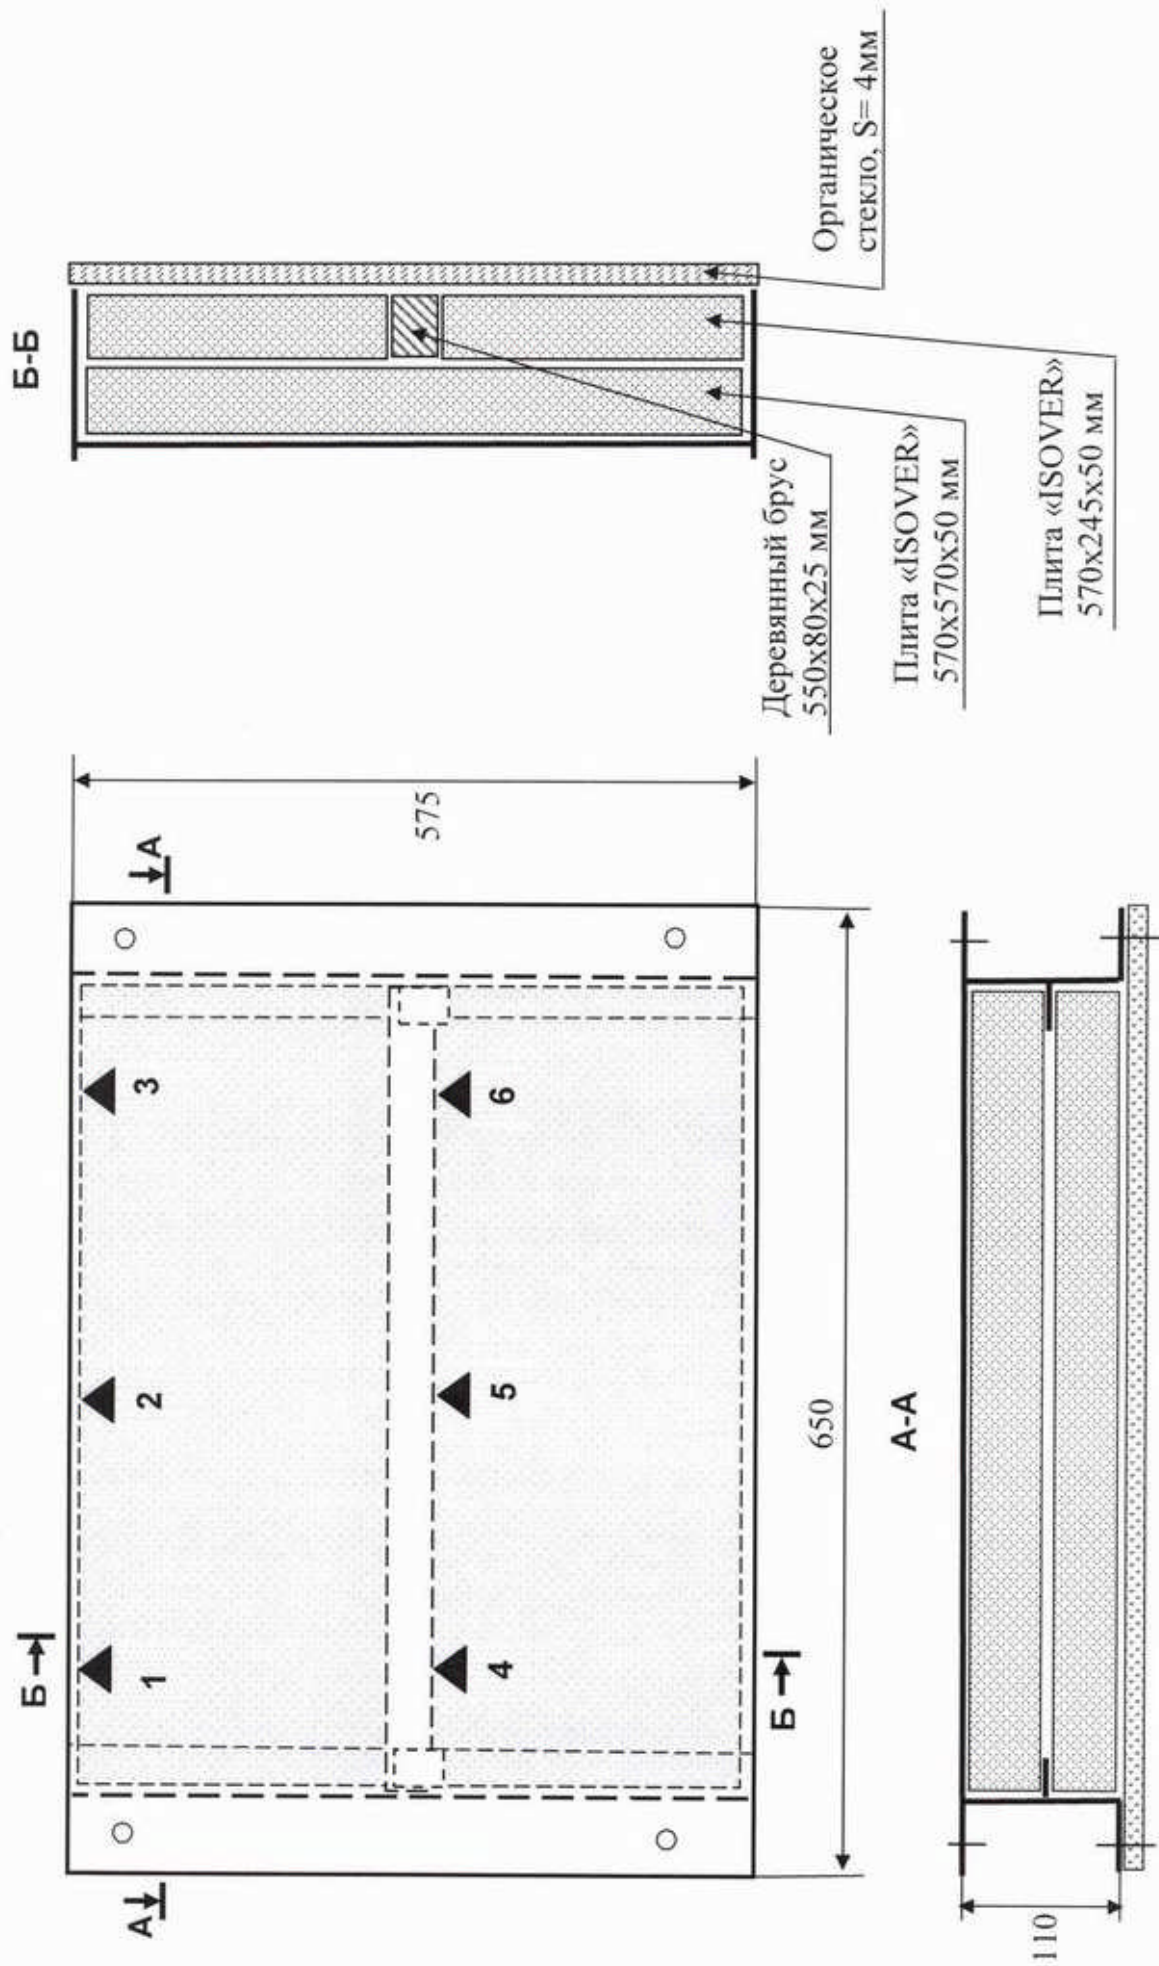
Макет фрагмента ограждающей конструкции боковой стенки с испытуемым теплоизоляционным материалом
